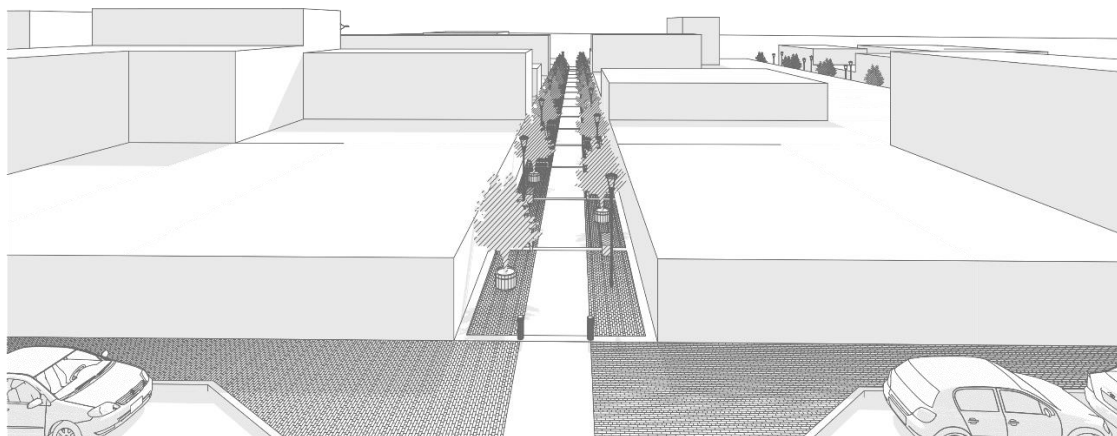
Propuesta de intervención de la calle peatonal barrio Sauces Norte
